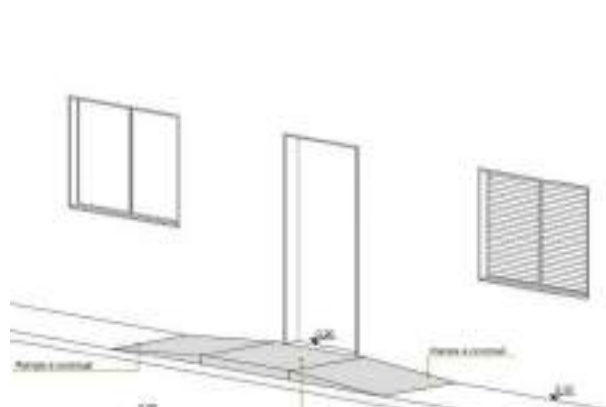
Croqui da perspectiva com a localização das rampas e patamar a serem construídos.
